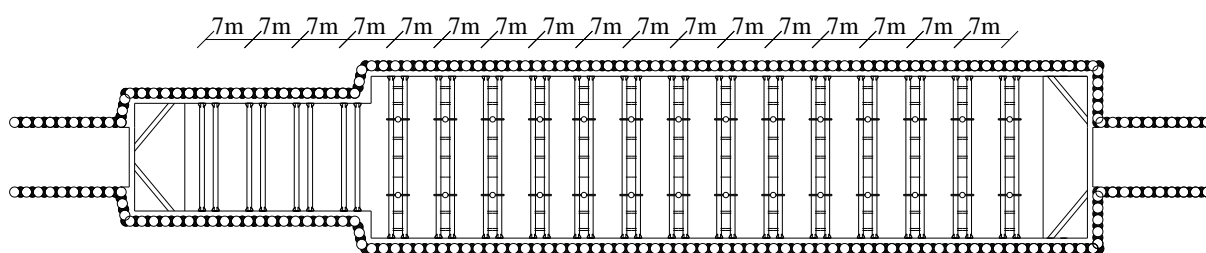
Disposição dos pares de escoras em planta (adaptado de Fernandes, 2006)
